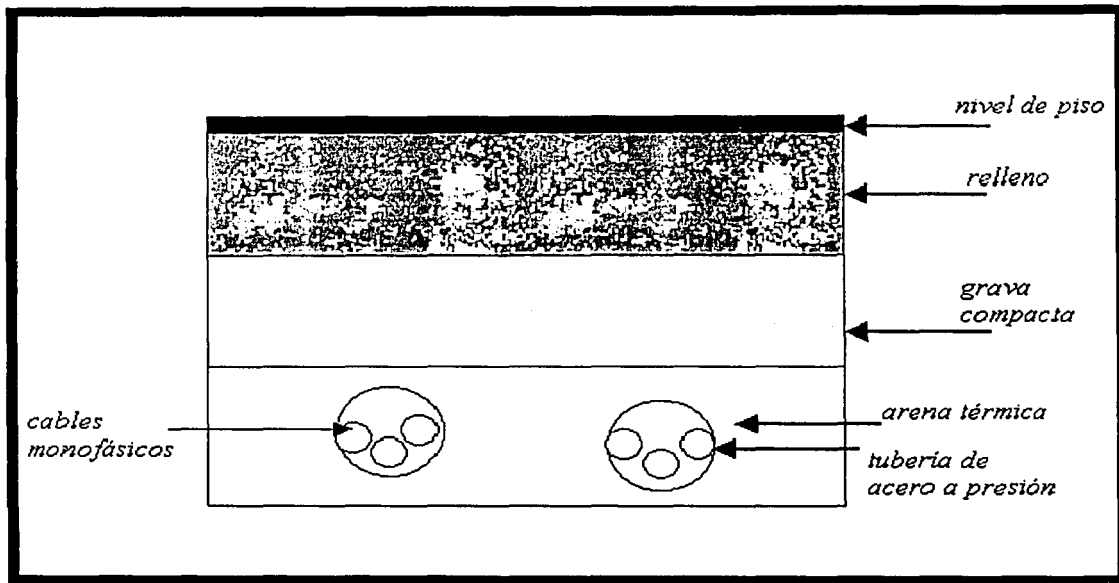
CORTE TRANSVERSAL DE DOS CABLES TIPO TUBO EN TRINCHERA
